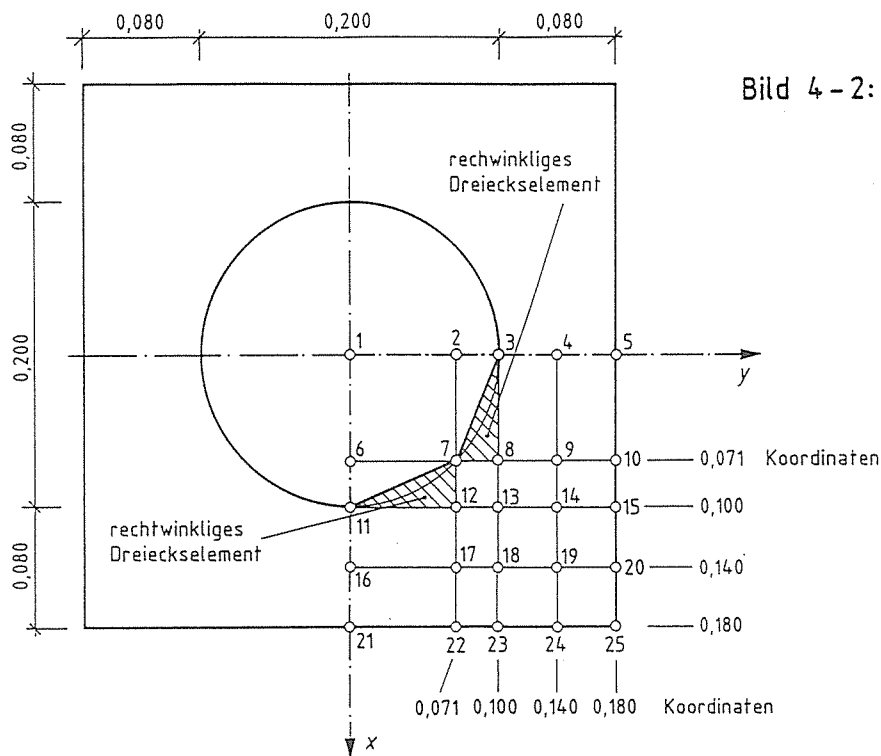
Elementierung eines Schornsteines mit rundem lichten Querschnitt von  $\phi 20$ cm (Bild 5-3)
